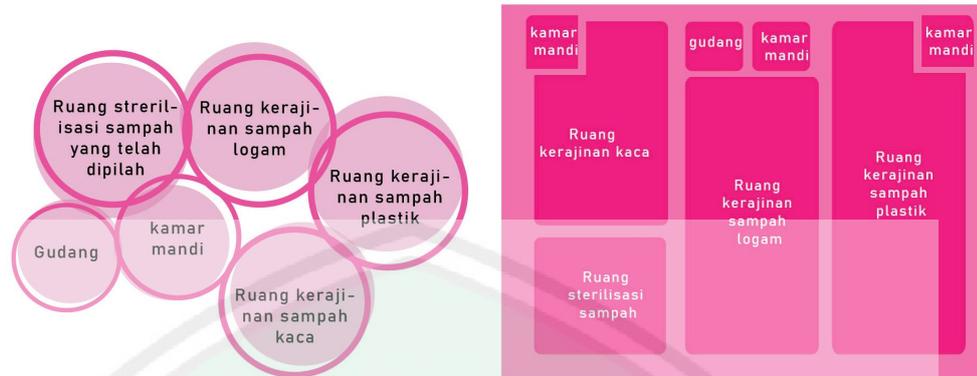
diagram keterkaitan dan blokplan ruang PLTSa
